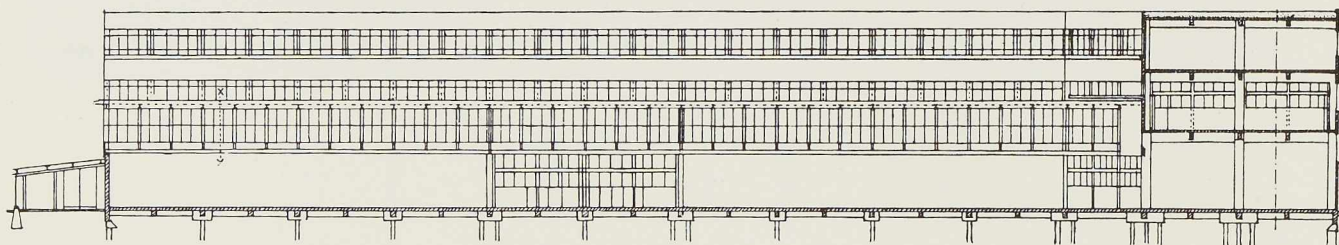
Coupe MN à travers les nouveaux bâtiments.
